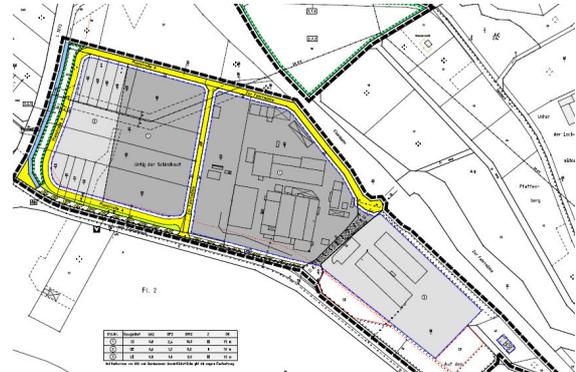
Beabsichtigte Festsetzung im Bebauungsplan
